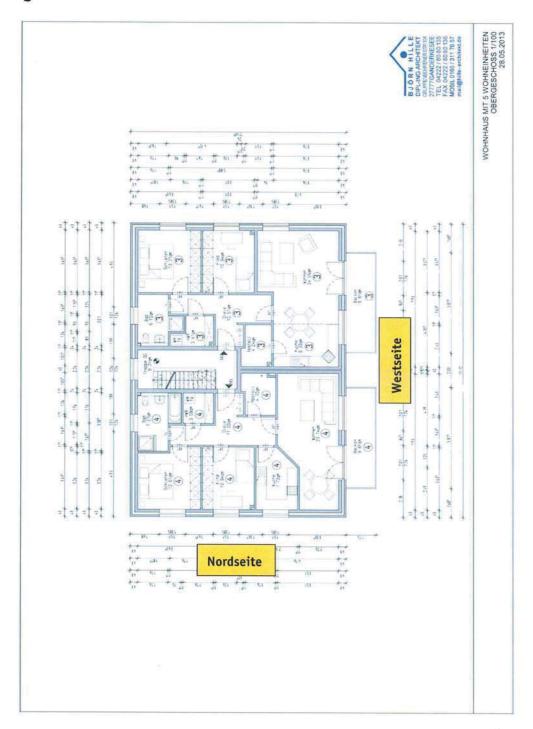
Das Gestaltungskonzept bzw. der Grundriss für das 1. Obergeschoss im 5-Parteien-Wohnhaus auf dem Plangebiet.
